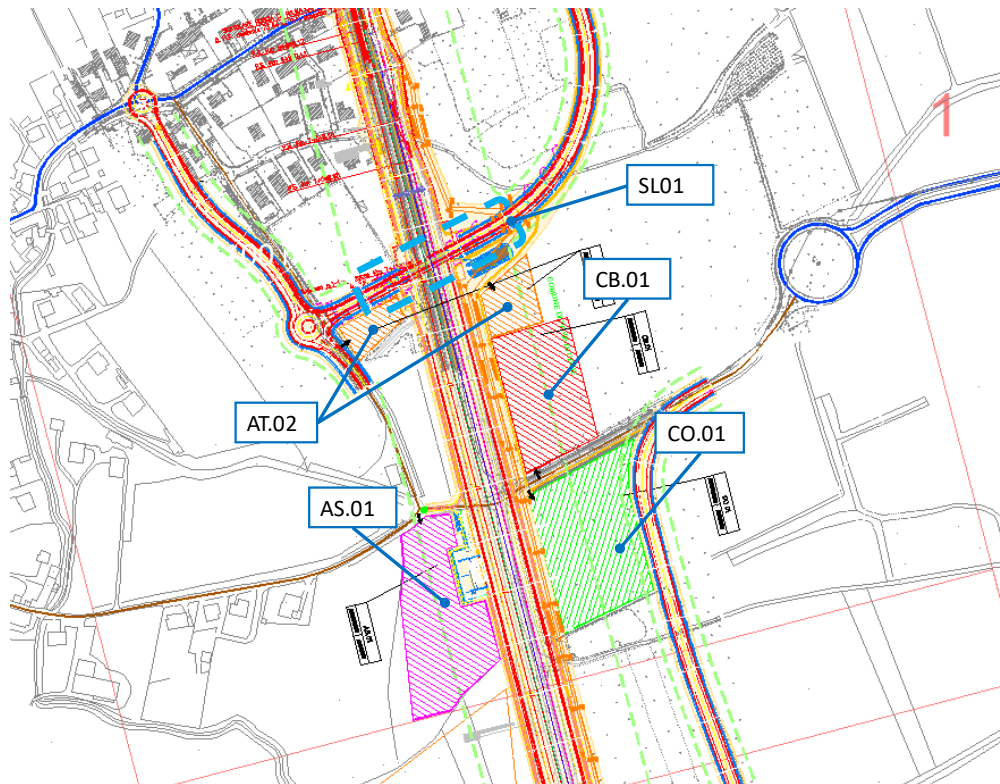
Localizzazione delle aree di cantiere e attività di lavorazione a Sud di Lumignacco
